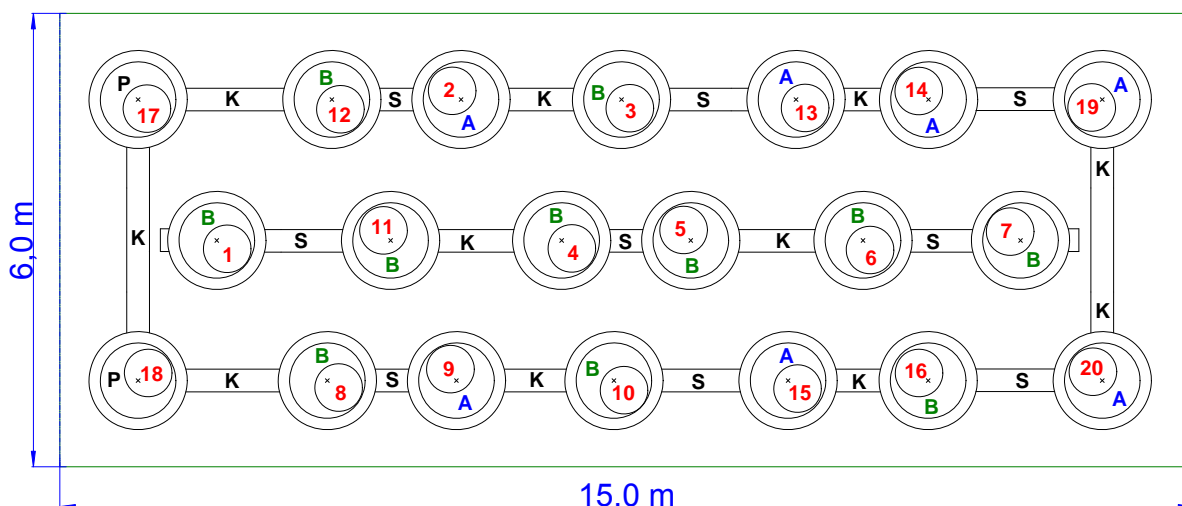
Skizze des Schachtaufbaus im Großversuchsstand – Grundriss
